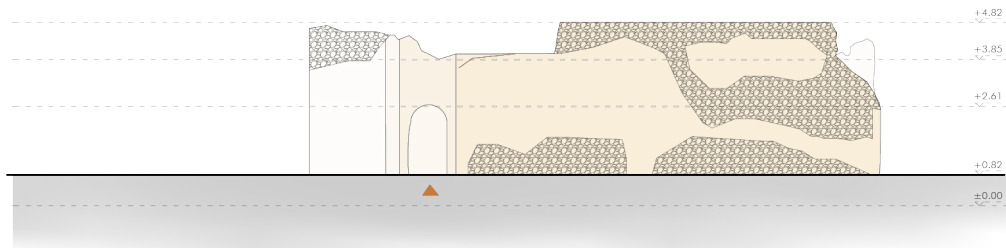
Prospetto est della casa 8. Scala 1/200
